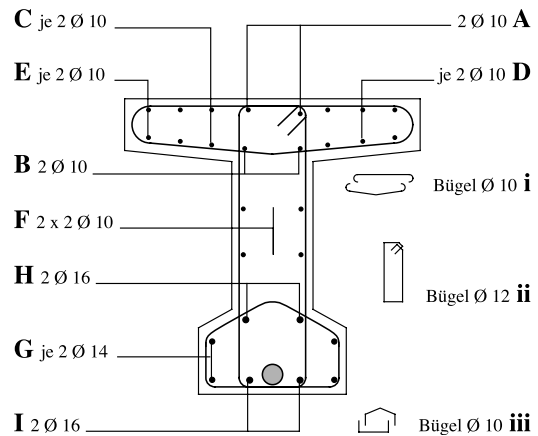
Bewehrungslayout im Querschnitt des Versuchsträgers T6, entnommen aus [5]
